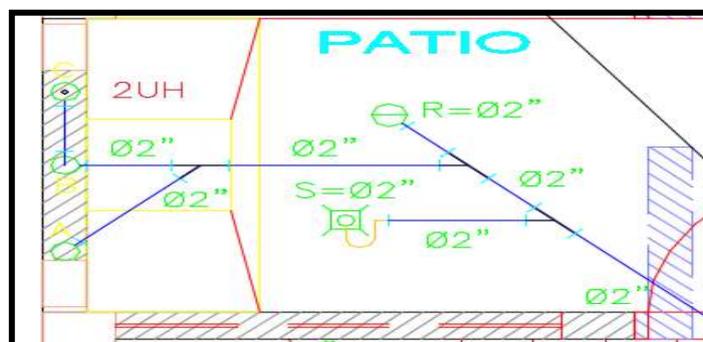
Distribución de descargas en Lavadero de Patio 1, Primer Nivel
